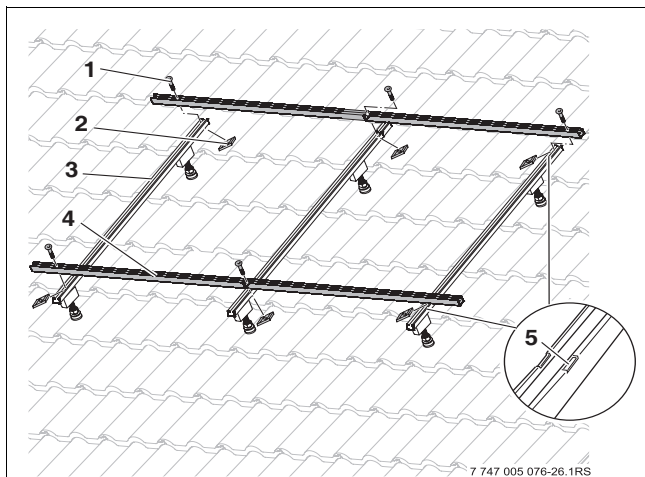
Fijar el perfil de cubierta plana/tejado inclinado al perfil del captador
